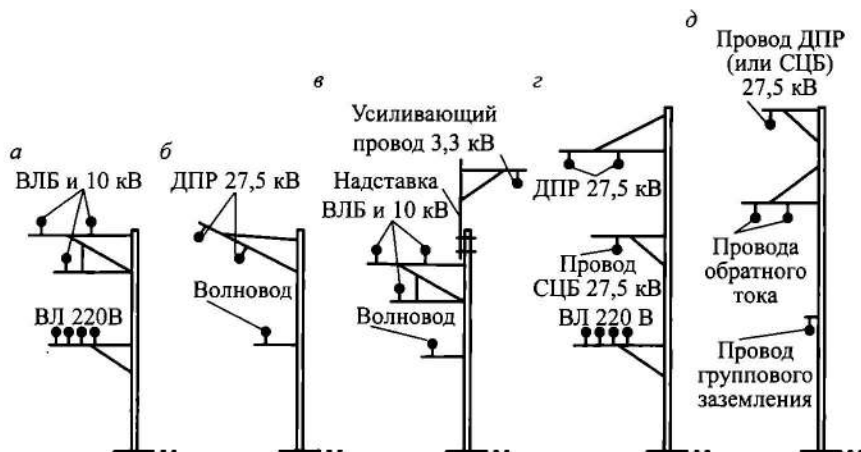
Схемы расположения проводов различных воздушных линий на консольных железобетонных опорах контактной сети (а—д)
